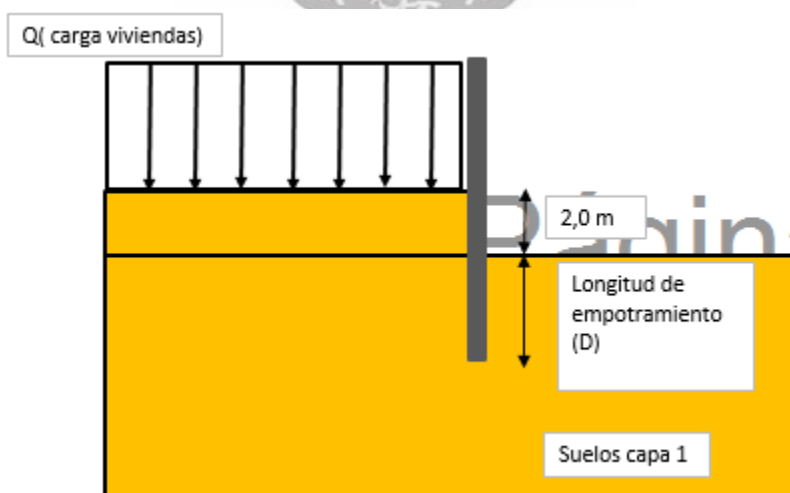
Esquema muro pantalla proyectado Pila 3
